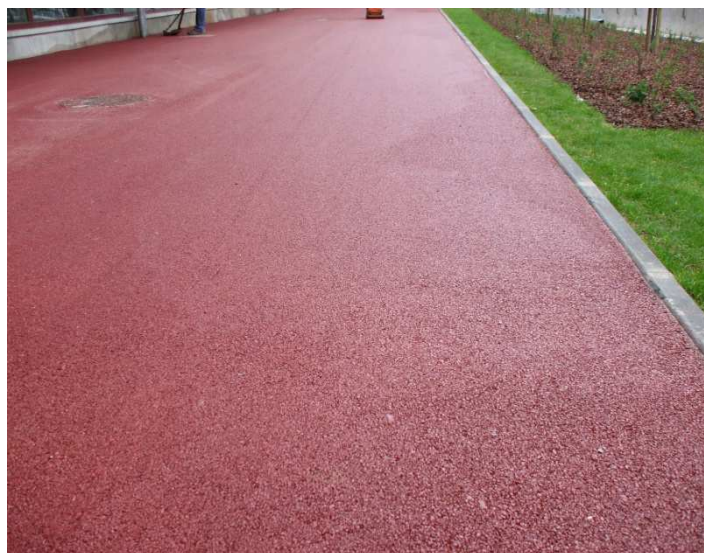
Pavimento colorido - Escola Secundária Jacôme Ratton
